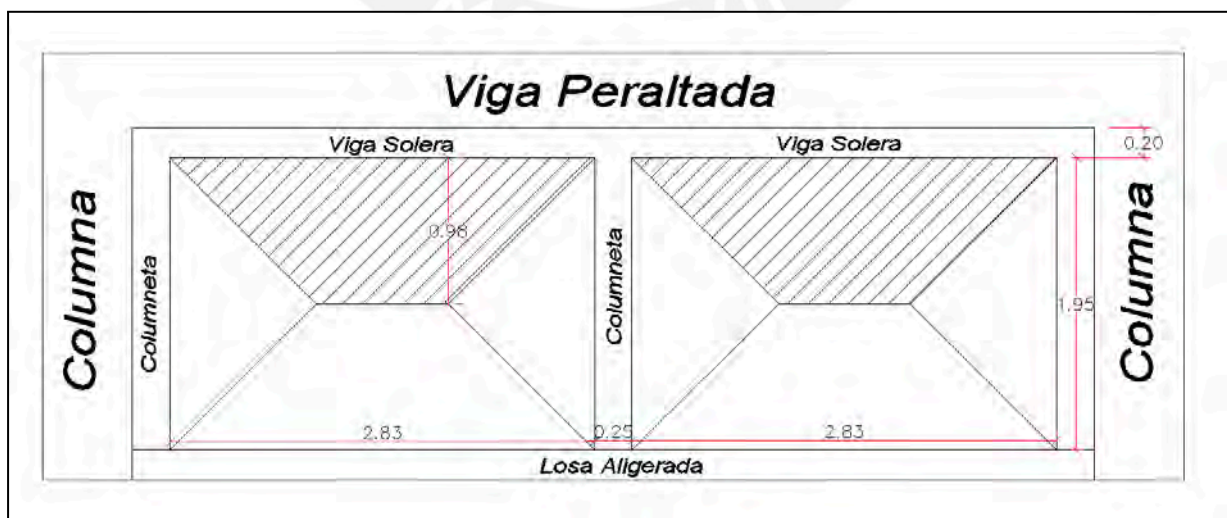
Distribución de cargas para viga solera. (Fuente:propia)
